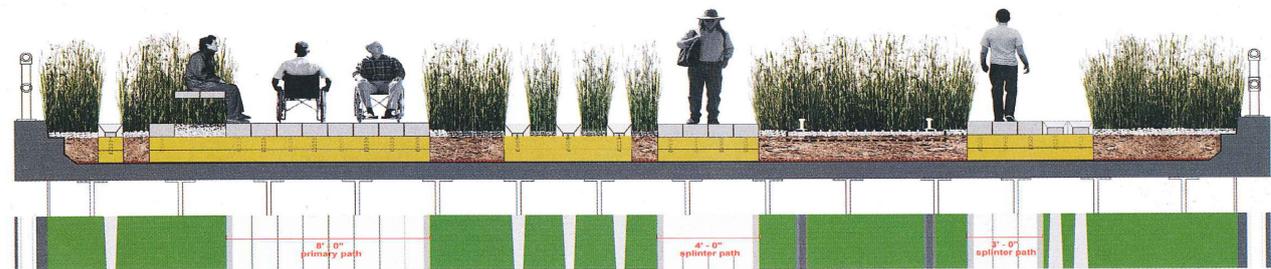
Esquema en sección del sistema de pavimento y vegetación.
